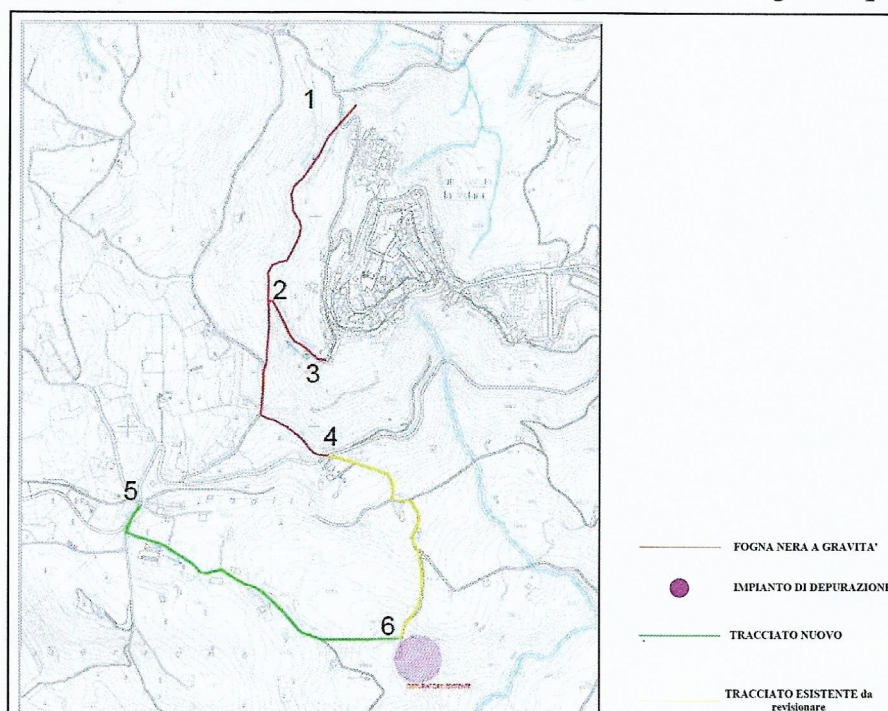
TAV-06 Planimetria particolareggiata rete fognaria
